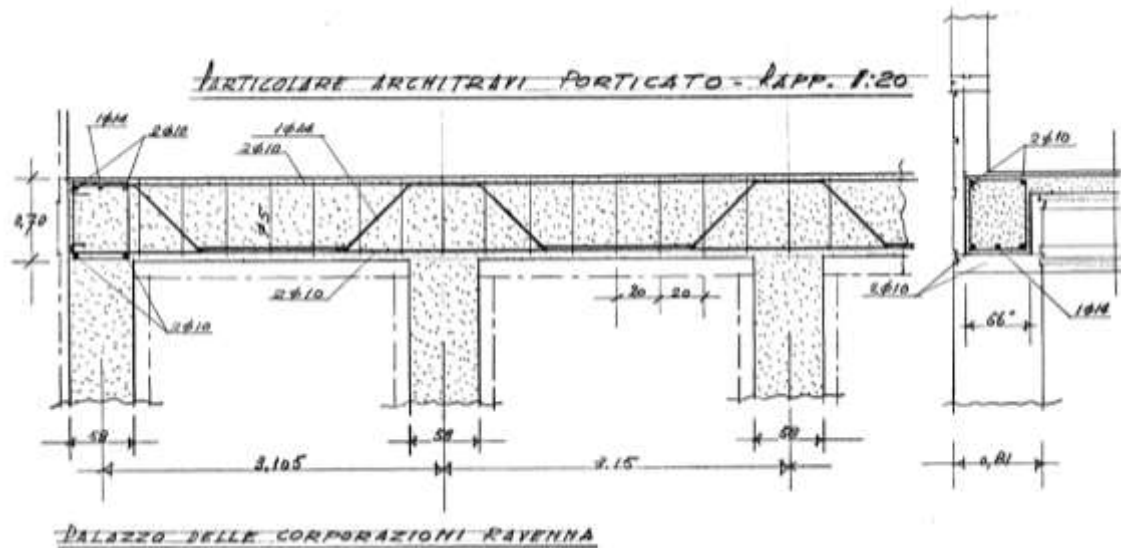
Dettaglio delle travi in c.a. che collegano i pilastri del portico; progetto preliminare.
